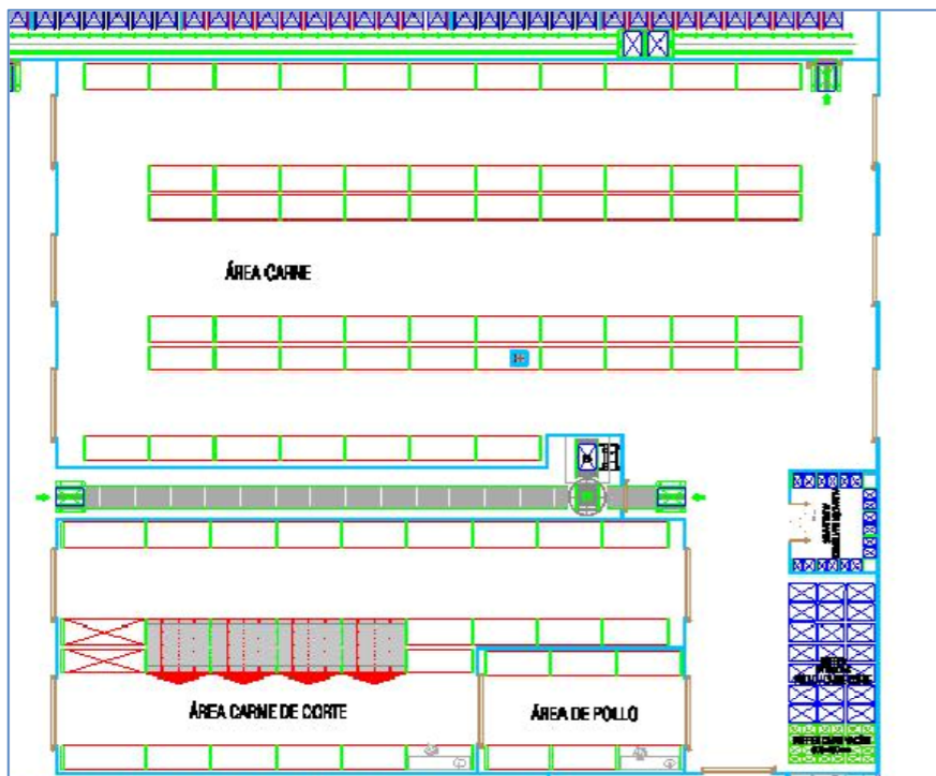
Detalle área estantería/paletización escenario semiautomático Fuente Elaboración propia
